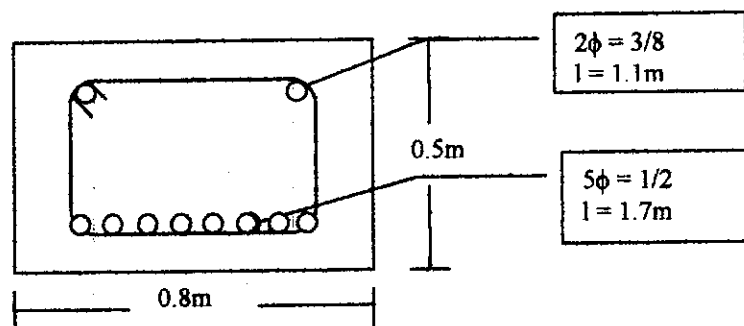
Detalle de refuerzo para anclar varillas No 8.
